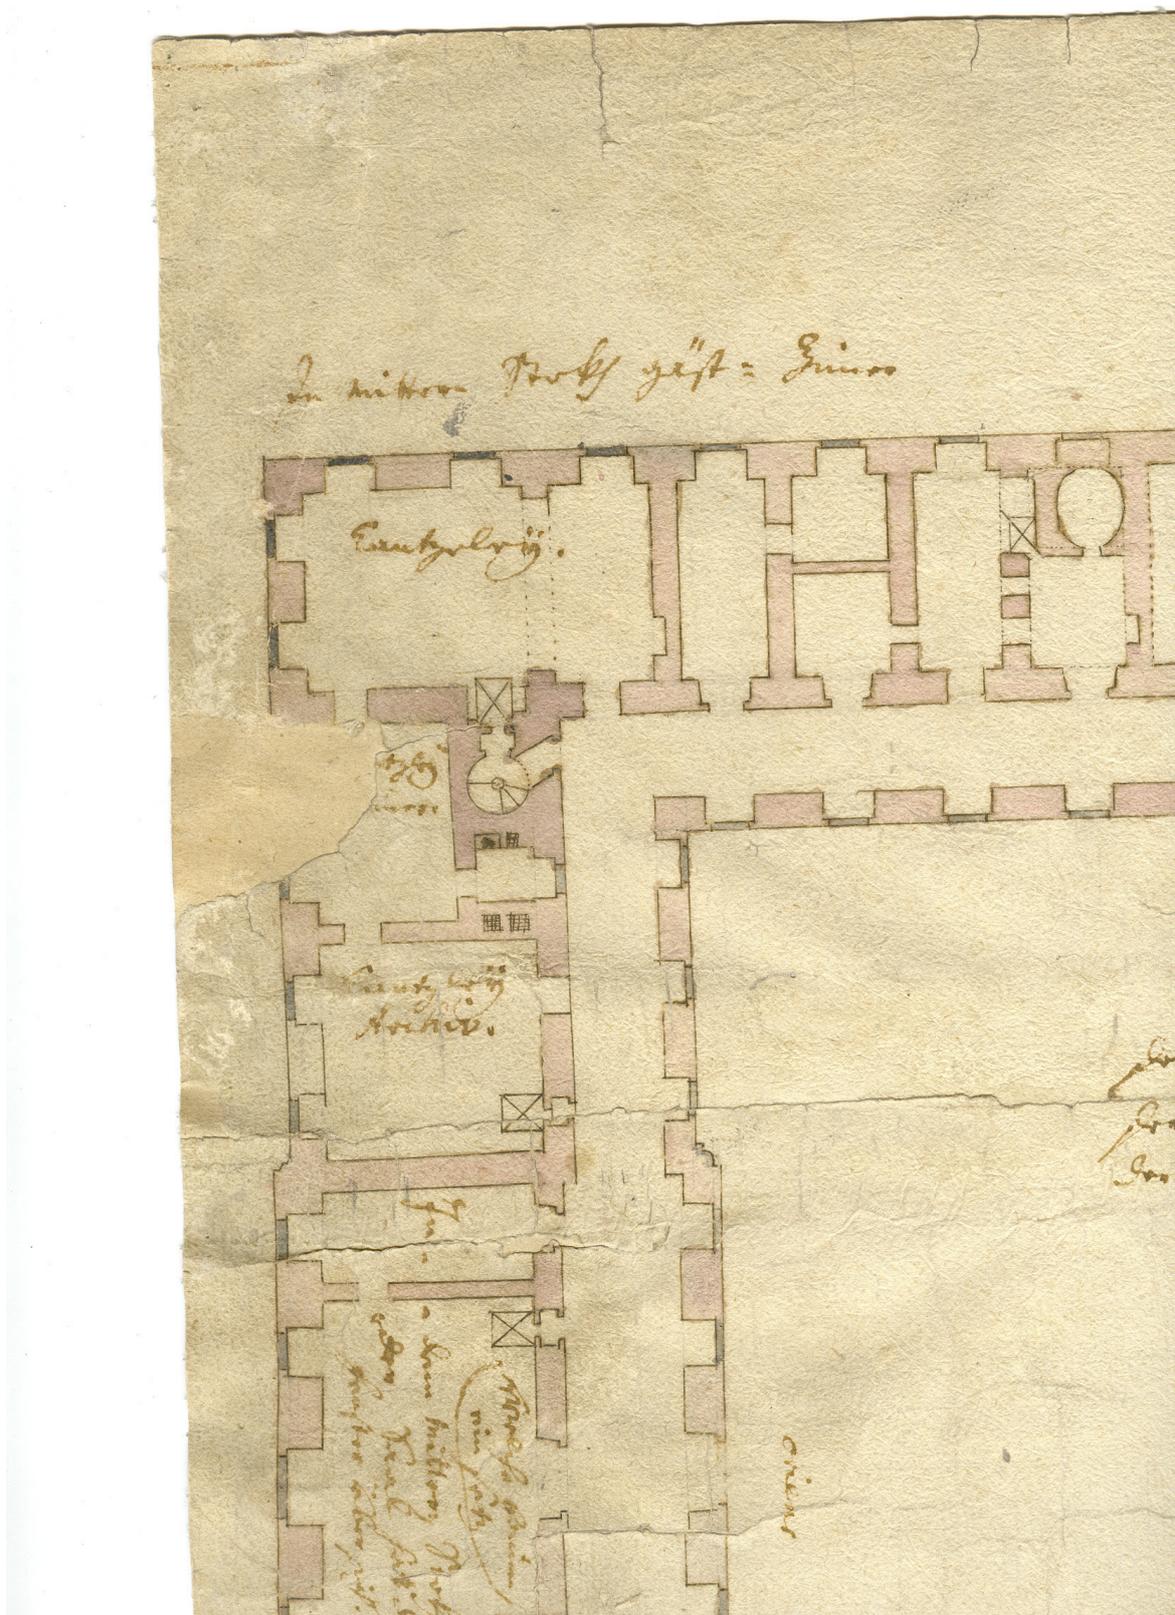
Detail aus einem Grundriss von Jakob Prandtauer, Projekt für eine neue Klosteranlage Herzogenburgs, 1714 (StAH, Plan Nr. 55).
